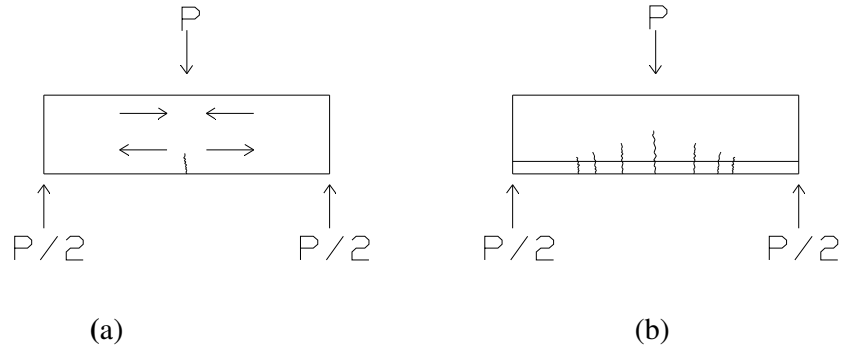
Beton kolonun yük altındaki çatlak gelişimi
